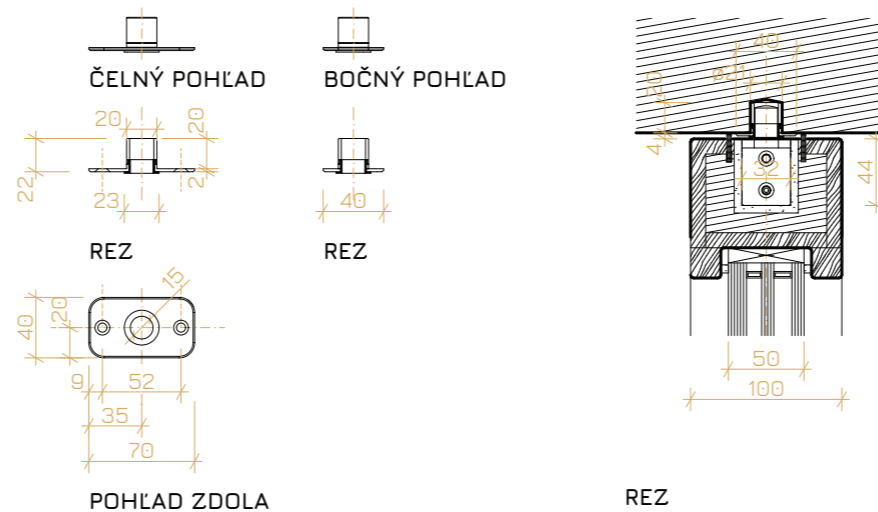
DETAIL DOLNÉHO PIVOTOVÉHO PÁNTU DVERÍ
